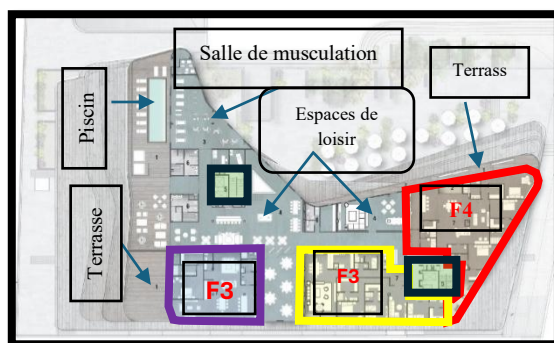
plan R+6 www.archdaily.com traite par les auteurs
